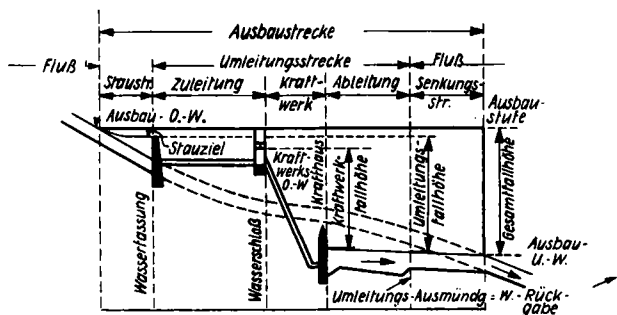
Allgemeines Grundschemata einer Wasserkraftanlage
